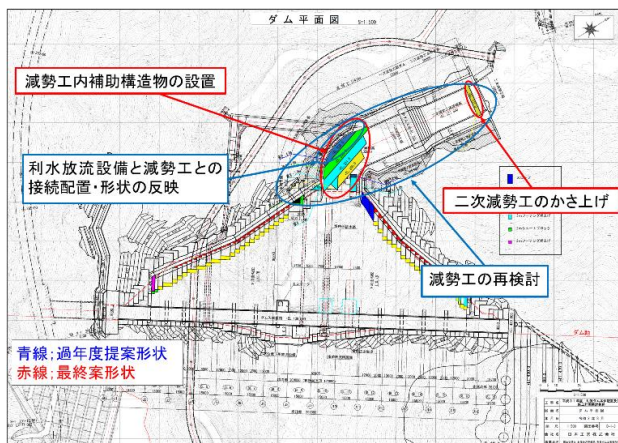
利賀ダム平面図（減勢工の改良点と課題箇所）
